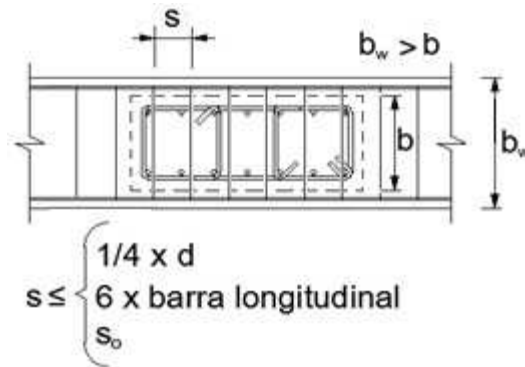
Detalhamento do estribo das vigas sobre o nó quando as vigas possuam parte de sua seção excedendo a dimensão do pilar
